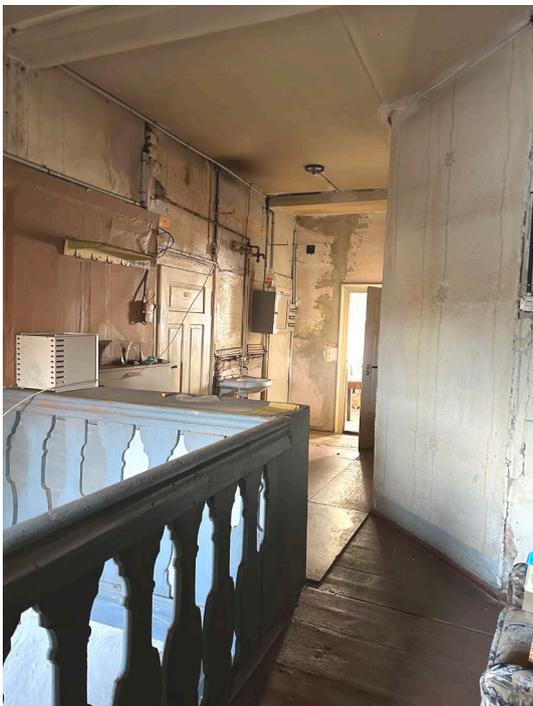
Vorderhaus, 1.Dachgeschoss, Teilansicht Hausflur
